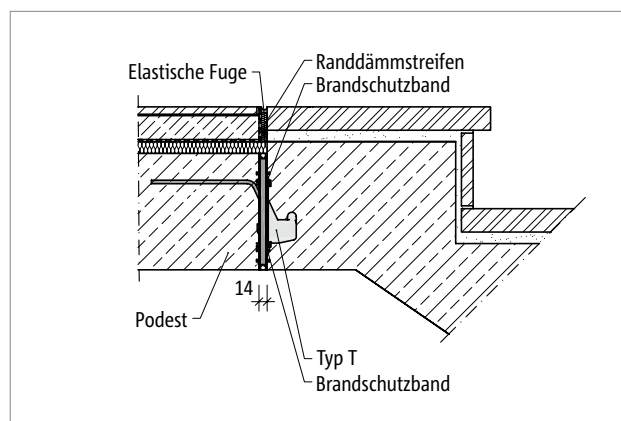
Schöck Tronsole® Typ T: Brandschutzausführung
